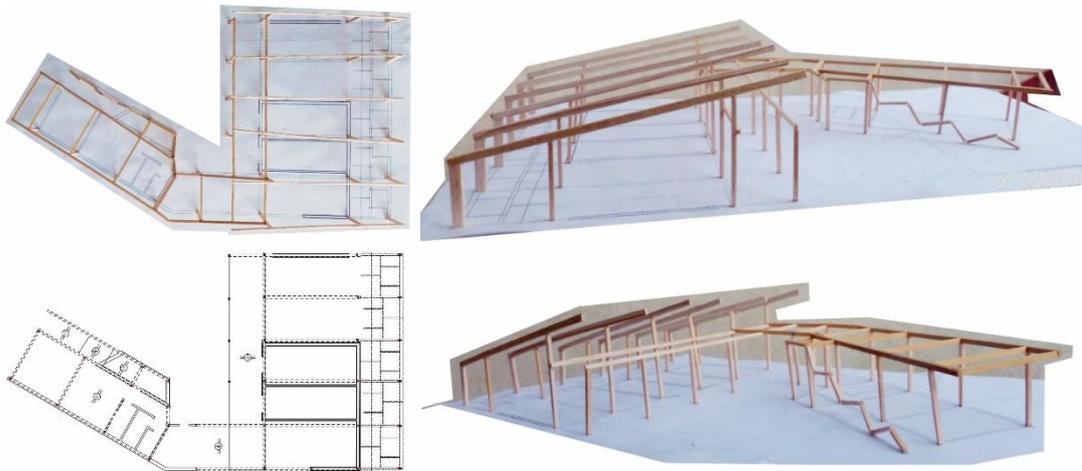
Estudio de la Estructura en Planta y Maqueta Esc.: 1:100.
